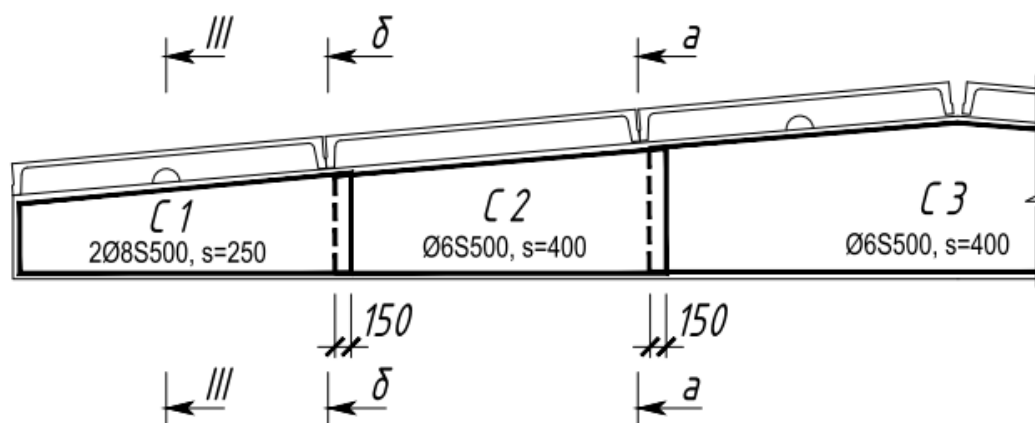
Схема расстановки сеток поперечного армирования по длине балки
